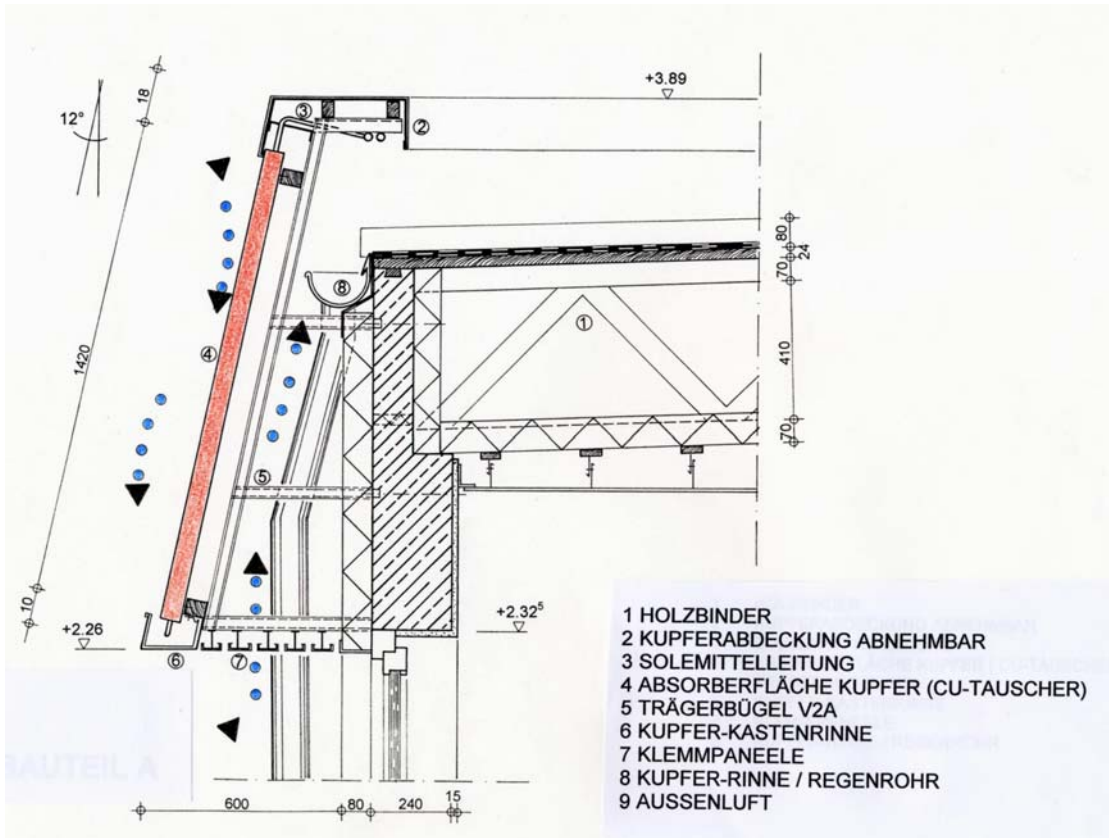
Dachattikablende, Detailzeichnung: Querschnitt der Blende mit Dachkonstruktion (unmaßstäblich), VEW AG, BD/DO, Abt. Bautechnik
